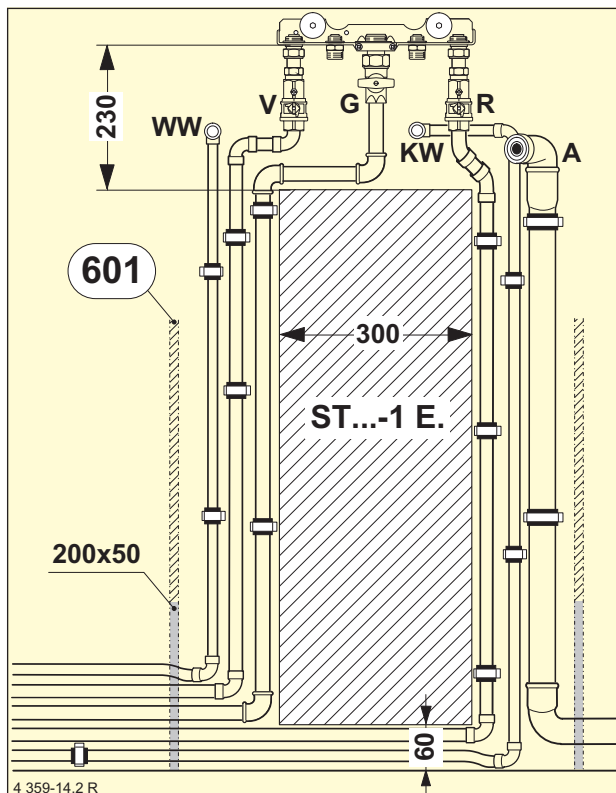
Bauseitige Aufputzverrohrung ohne Wandabstand.
